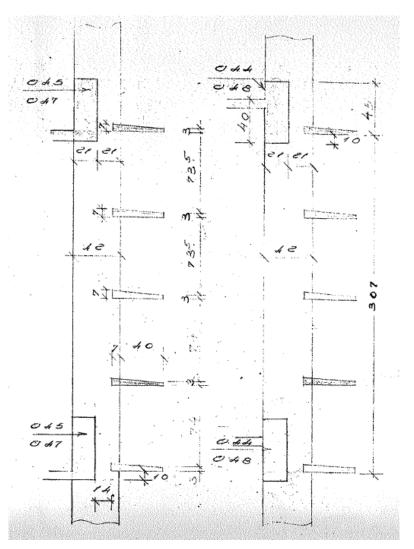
Corte dos brises retirada do projeto original de estruturas.
